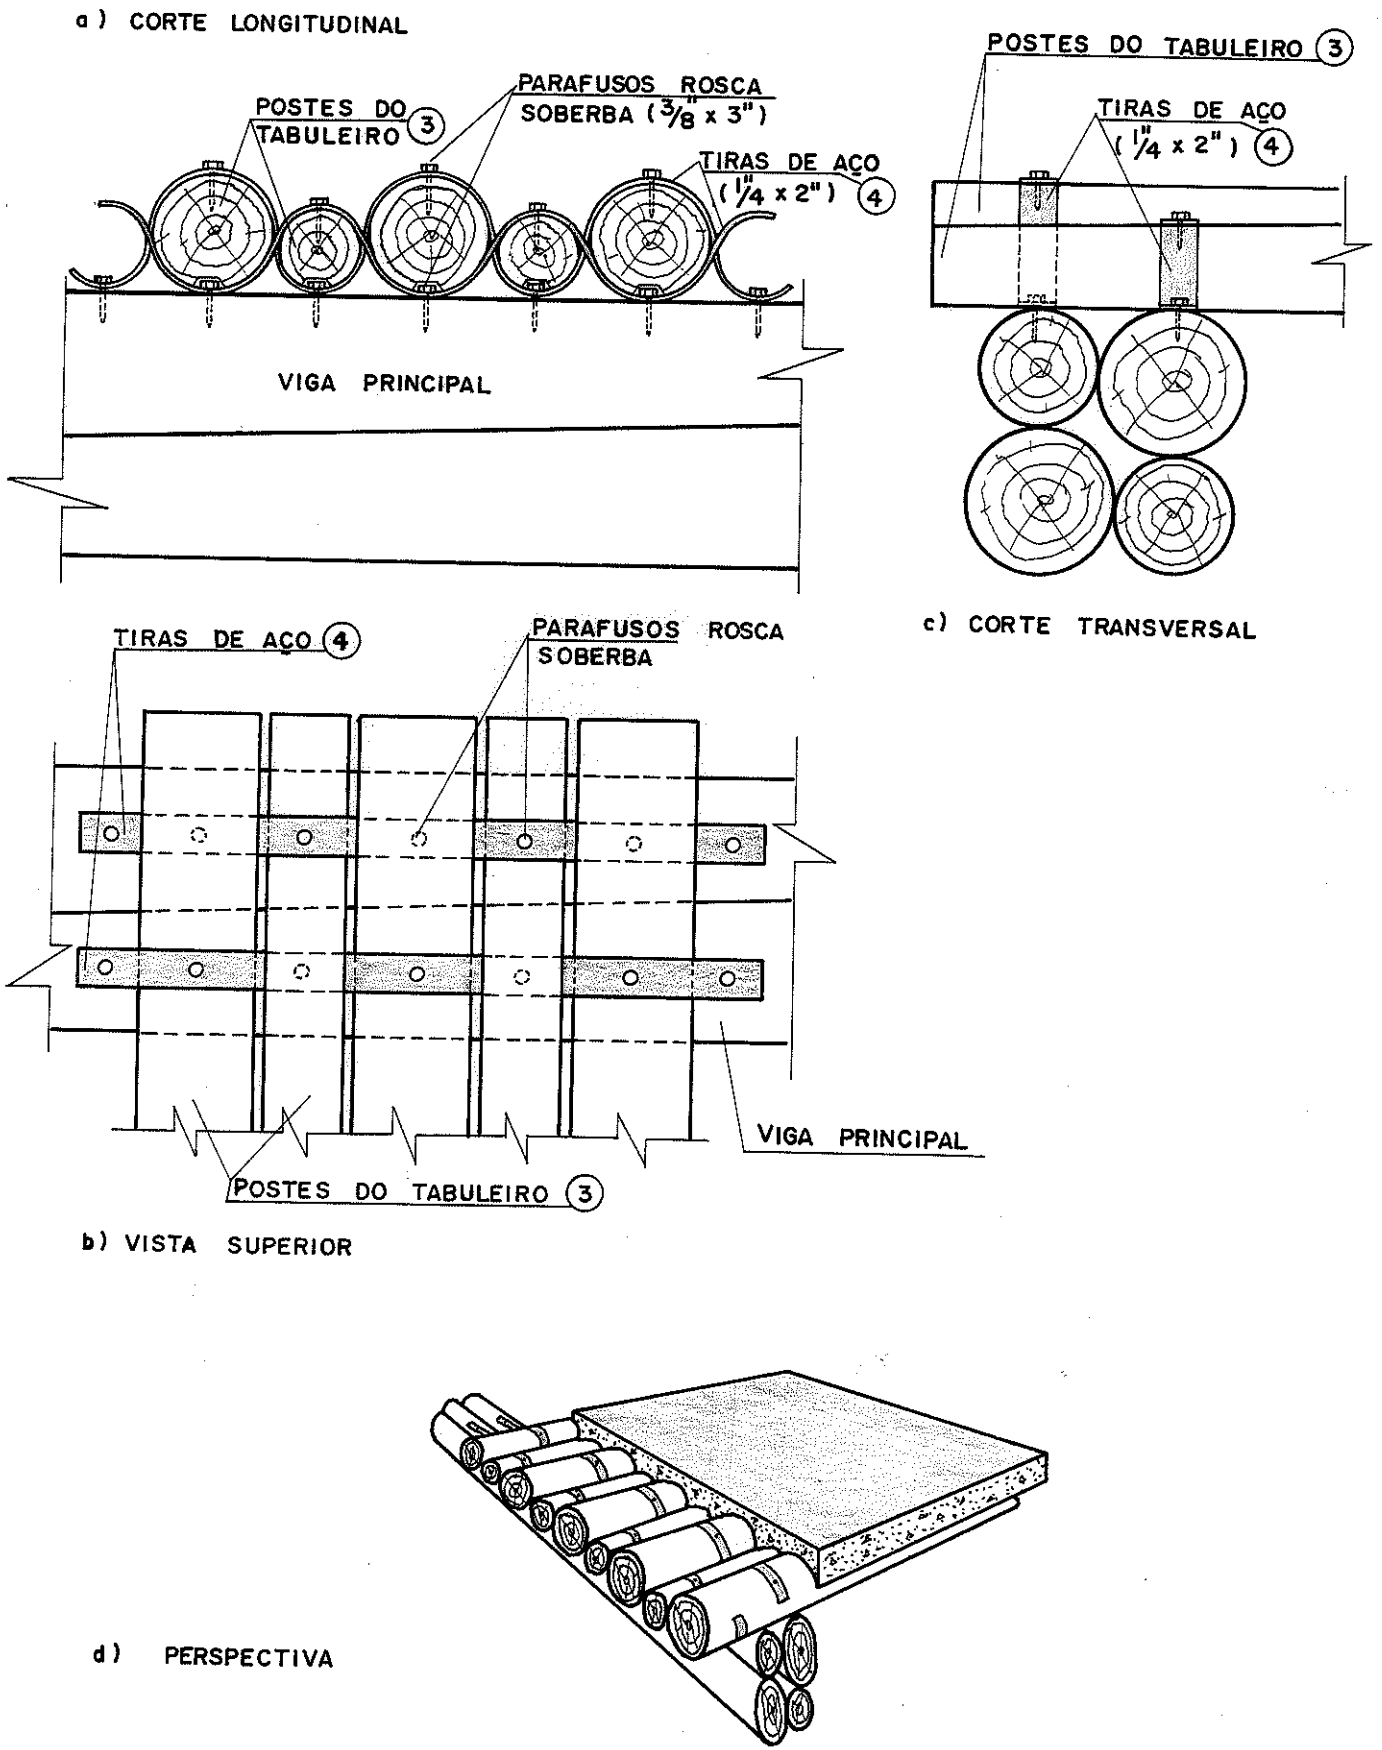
DETALHE DE FIXAÇÃO DO TABULEIRO
